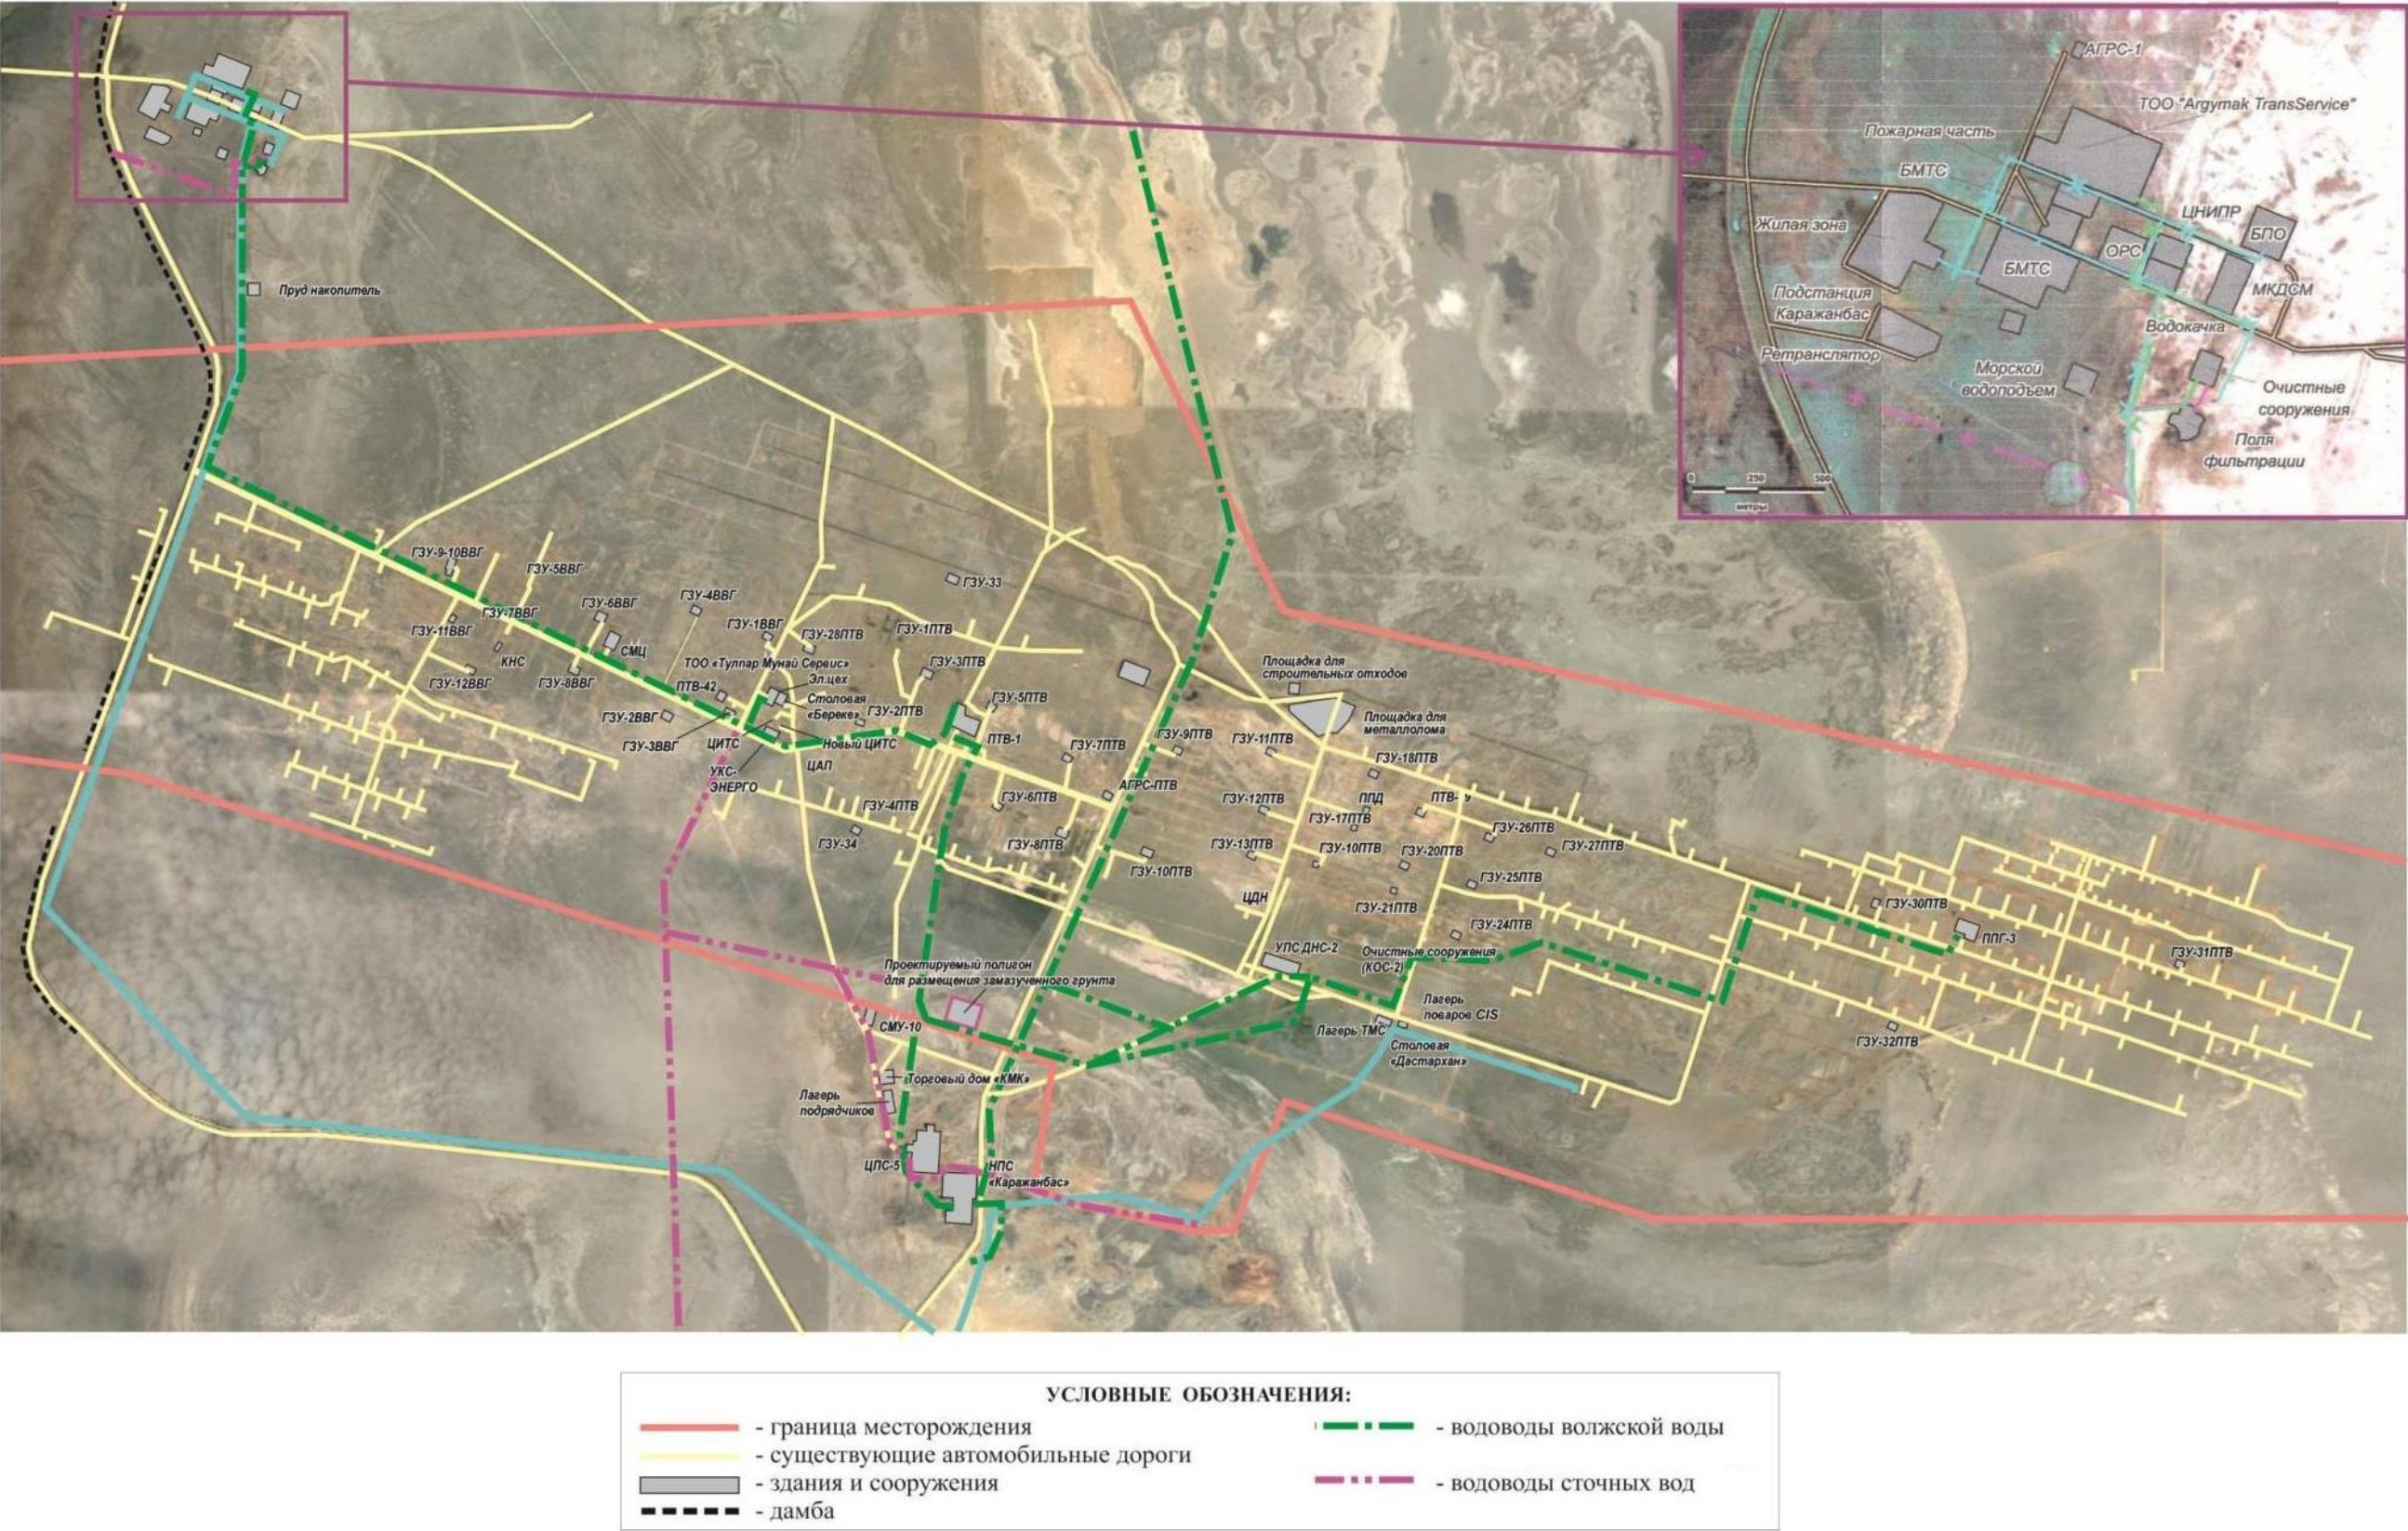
План сетей водоснабжения м/р Каражанбас
